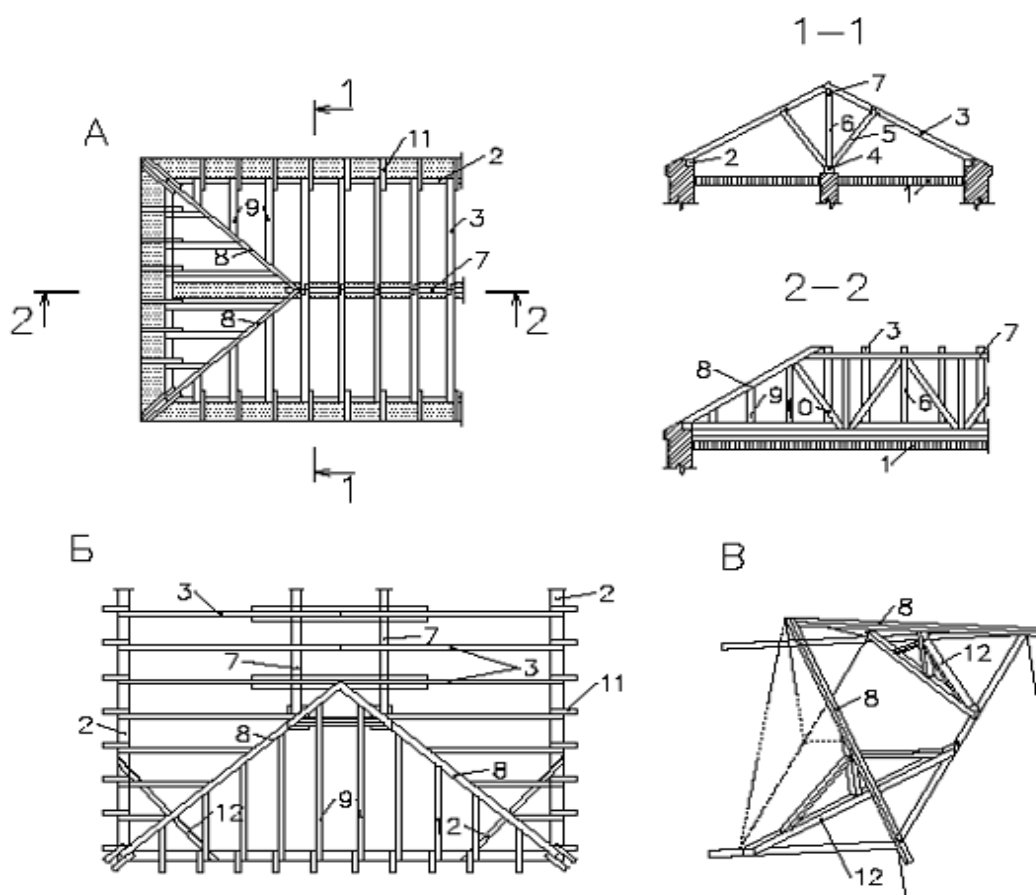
Расположение в плане наслонных стропил в зданиях:
